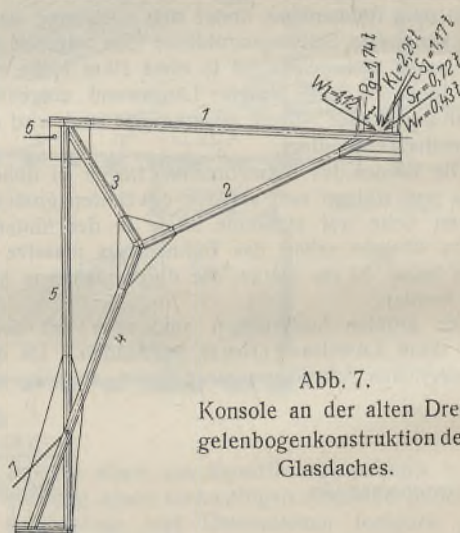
Konsole an der alten Dreigelenbogenkonstruktion des Glasdaches.
